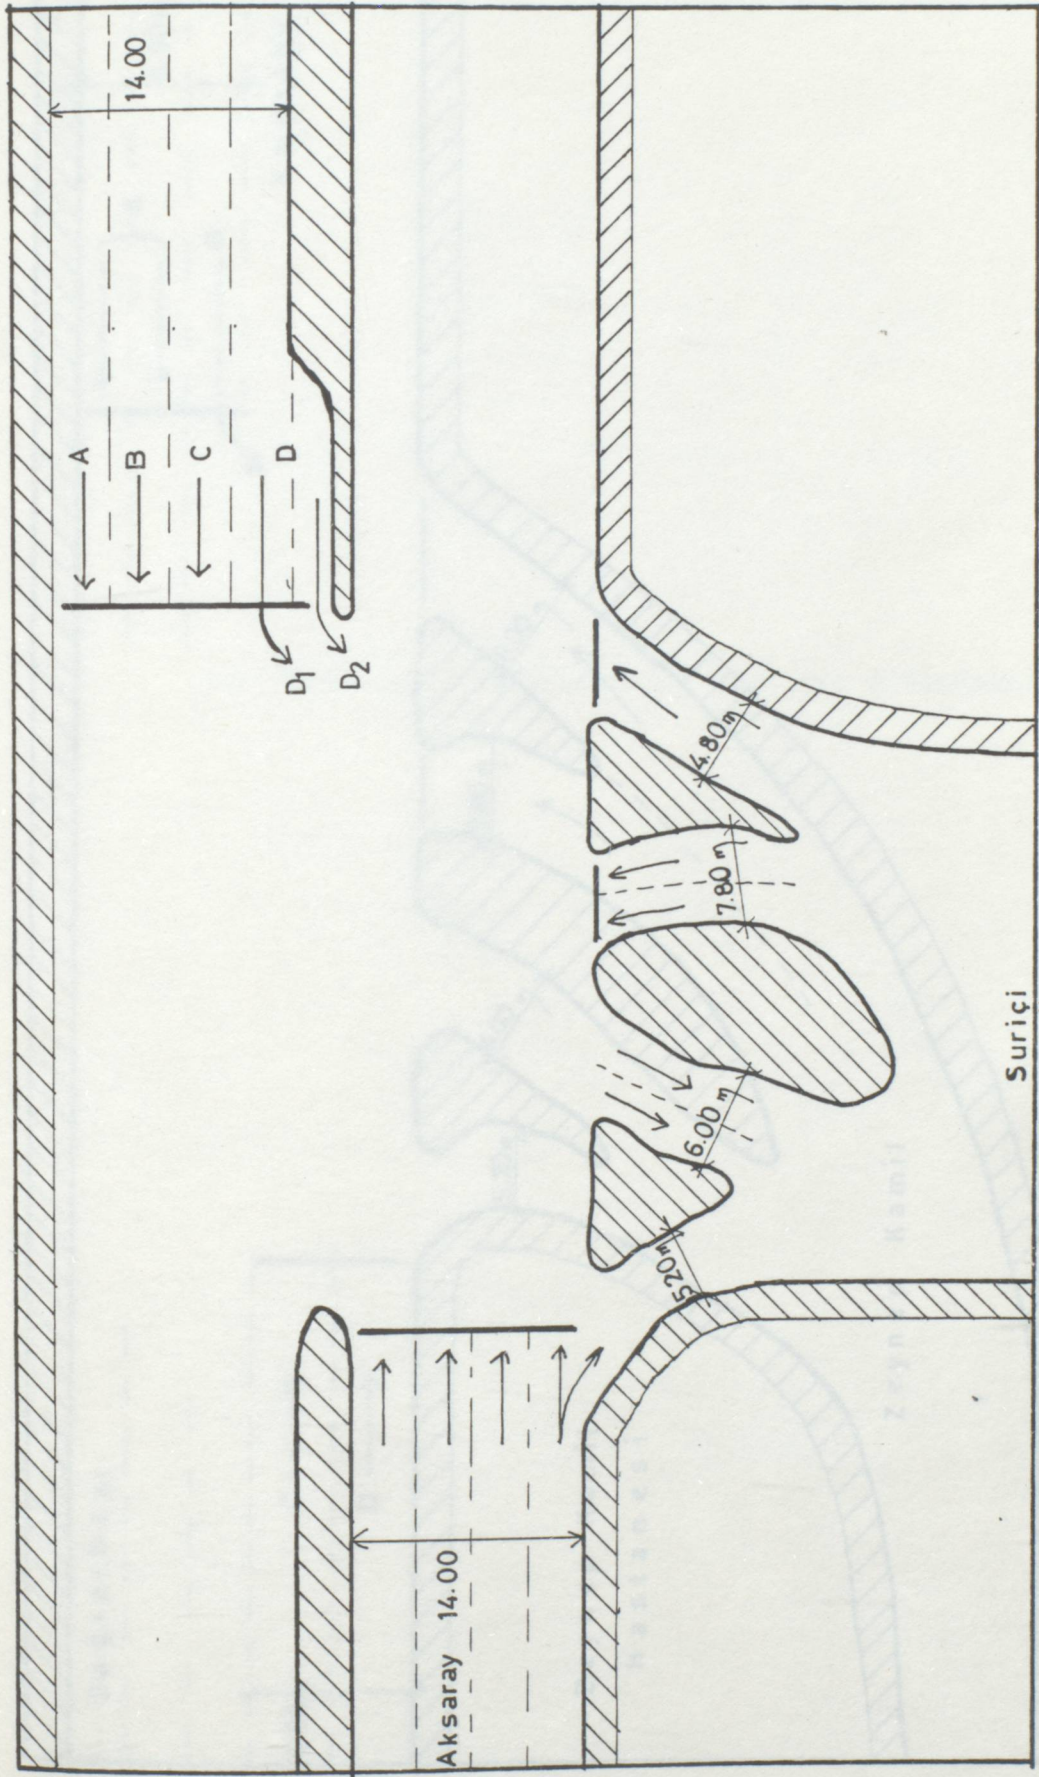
EDİRNEKAPI KAVŞAĞI PLAN VE ÖZELLİKLERİ
